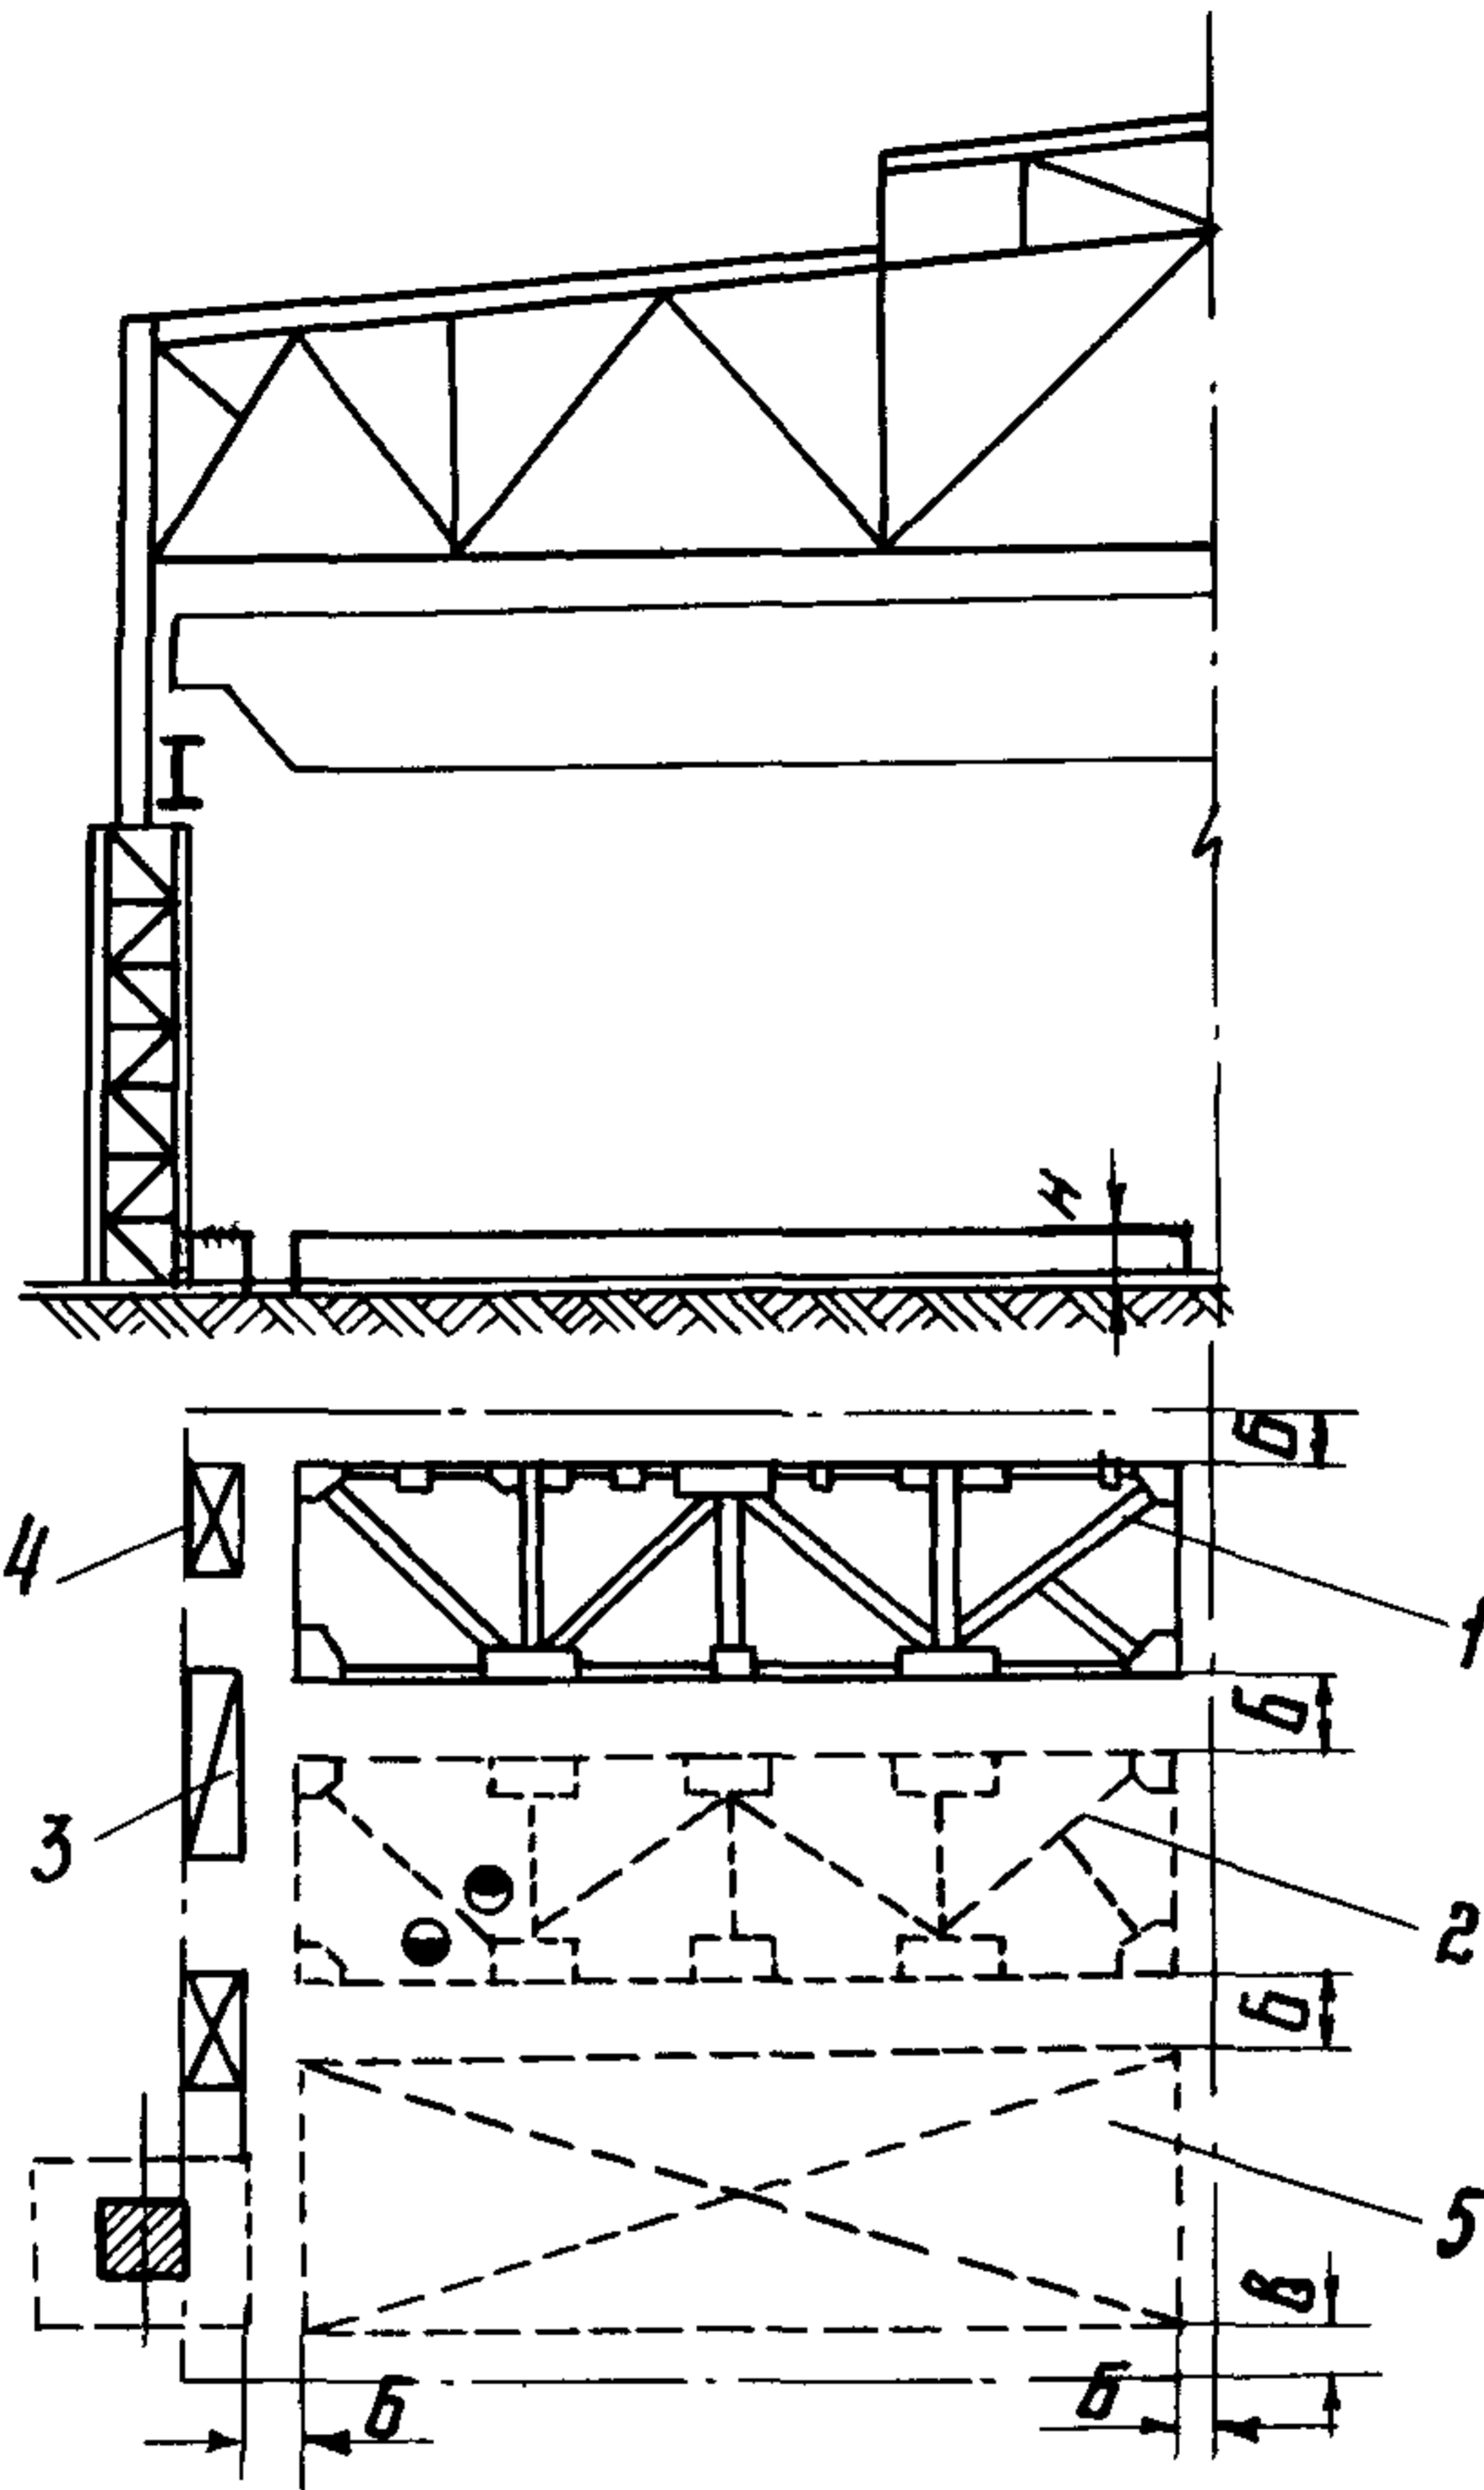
Размещение участка для сборки конструкций в поперечном пролете:
